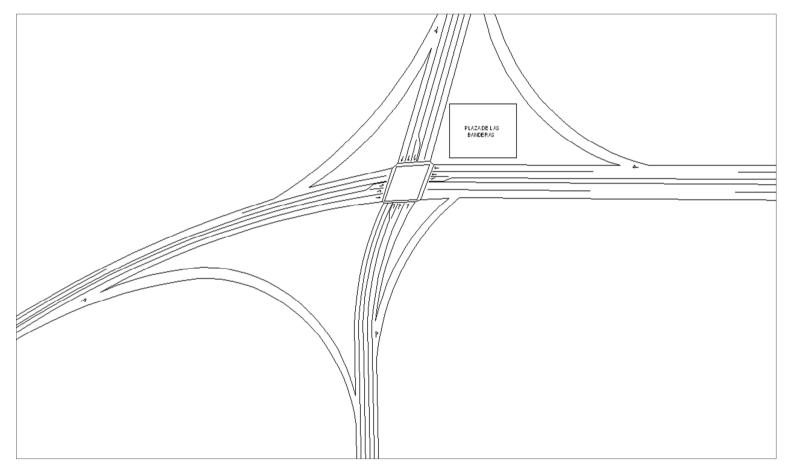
Vista en planta de la propuesta en la plaza Las Banderas.
